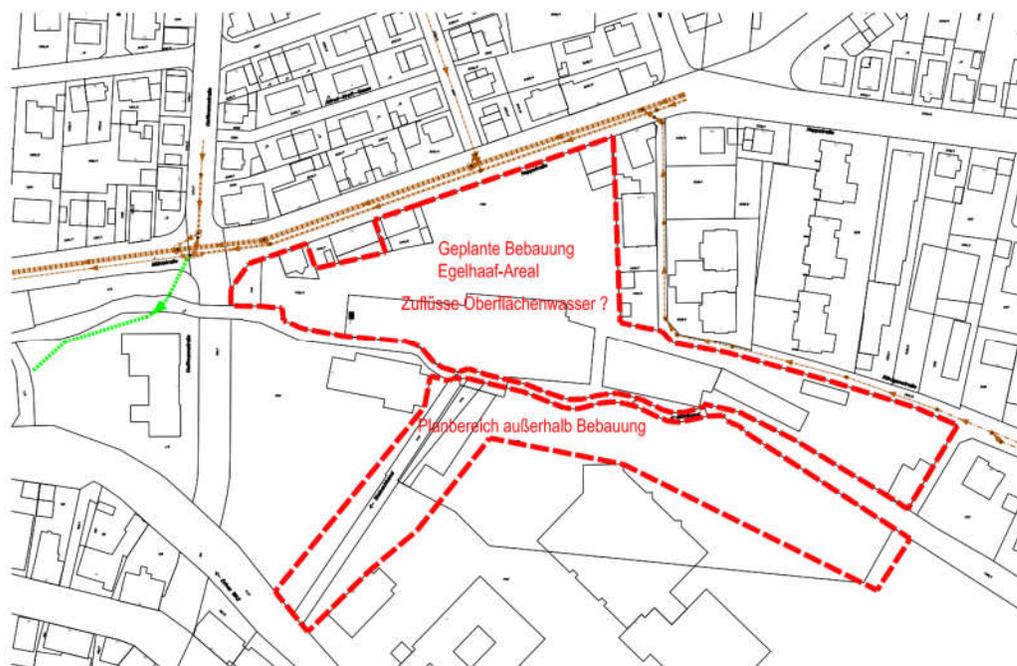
Lageplan – Untersuchungsgebiet: Egelhaafareal, Betzingen, Reutlingen)
